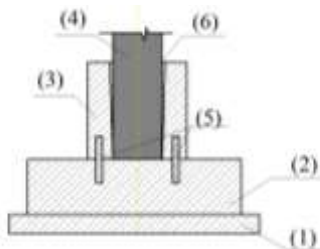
Схема влаштування фундаменту із монолітною фундаментною плитою та збірним стаканом типу СВ:
